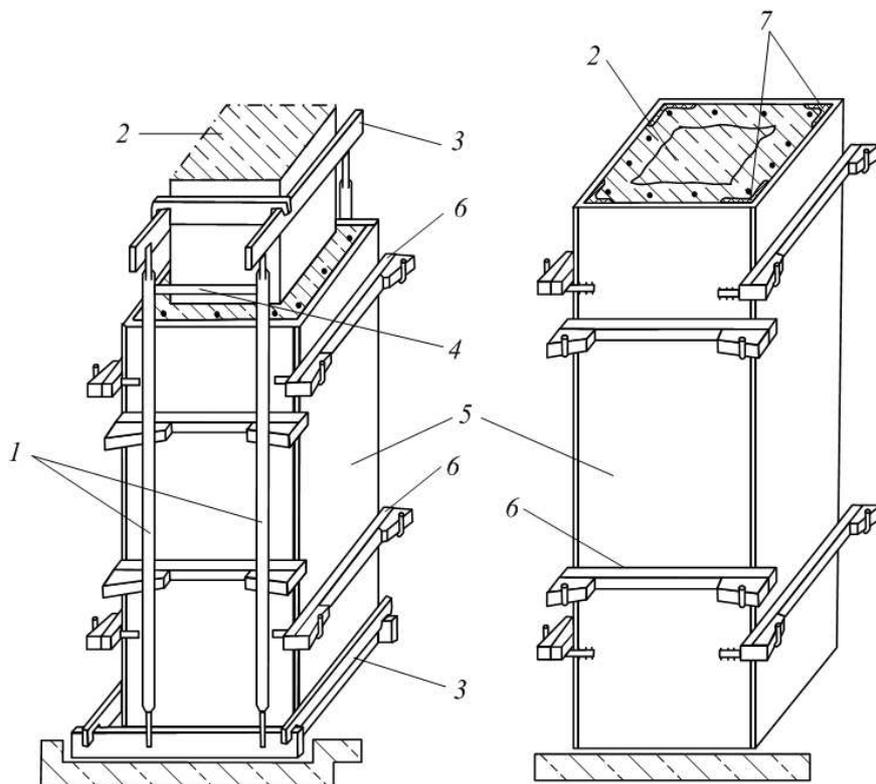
Крепление щитов опалубки: *а* – на высоких инвентарных стойках; *б* – на жесткой арматуре; 1 – стойка; 2 – колонна; 3 – схватка; 4 – ригель; 5 – щитовая опалубка; 6 – брус для крепления щитов; 7 – жесткая угловая арматура
